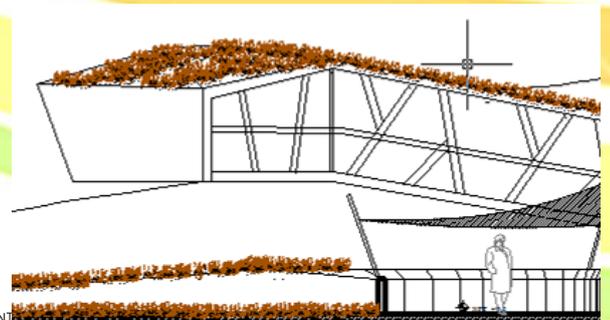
sistema de cubiertas verdes aplicado al proyecto.
